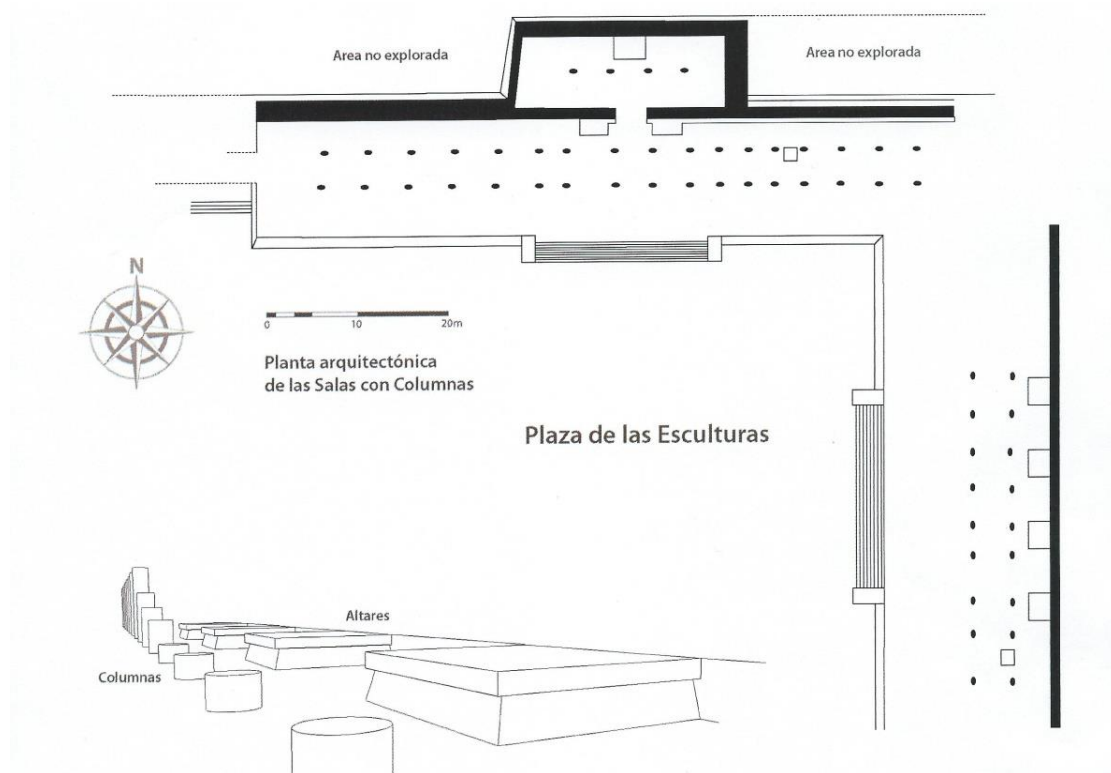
Planta arquitectónica de las Salas con Columnas, a la derecha Sala con Columnas de los cuatro altares, arriba sala con Columnas norte o con banqueta. Dibujo Adrián Colchado, INAH, 2008.
